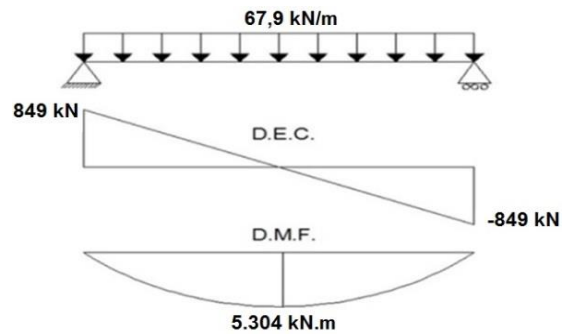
Esforços solicitantes na viga de aço preenchida com concreto.
